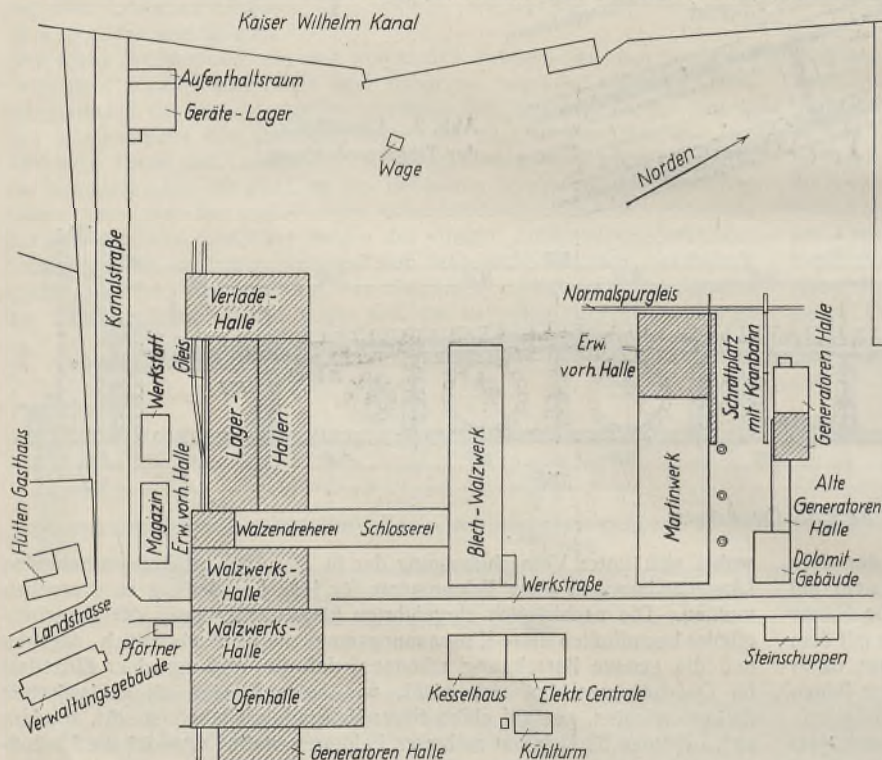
Gesamtanlageplan (die neuen Hallenbauten sind schraffiert dargestellt).
